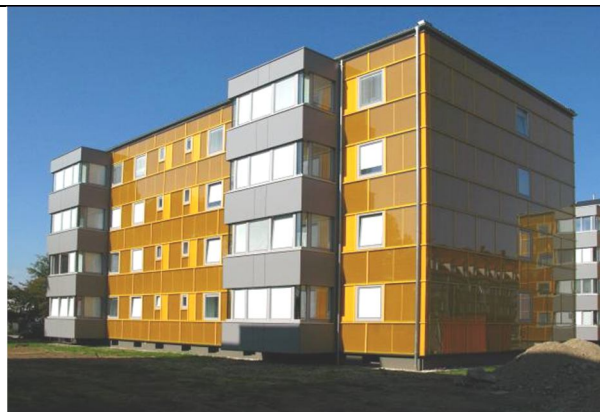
После реконструкции жилого здания в г. Грац (Австрия) балконы застеклены и расположены в пределах теплового барьера оболочки здания.
